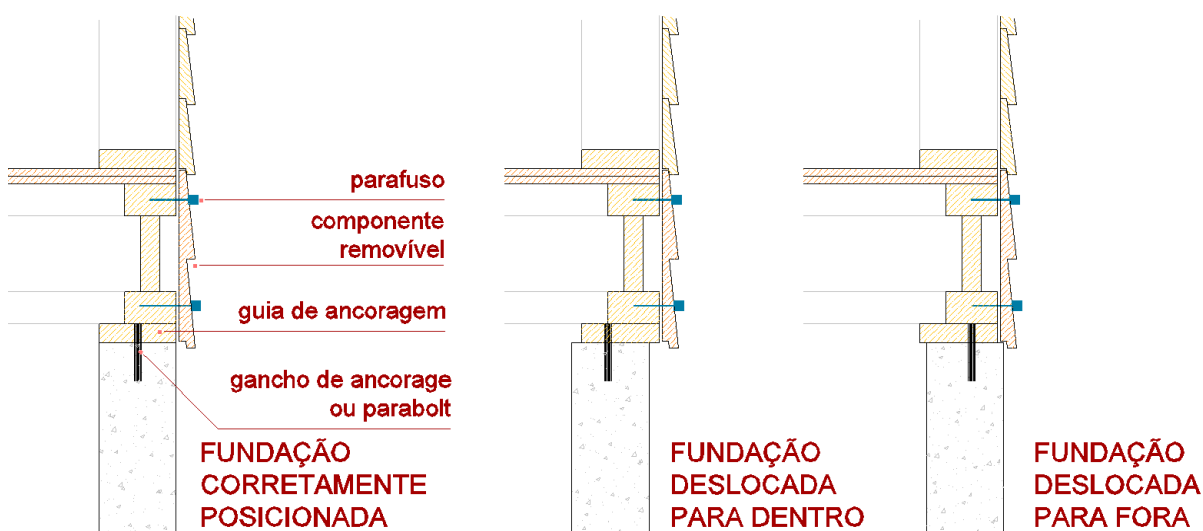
Ajustes sobre a fundação (sapata corrida ou sapatas isoladas com vigas baldrame)
